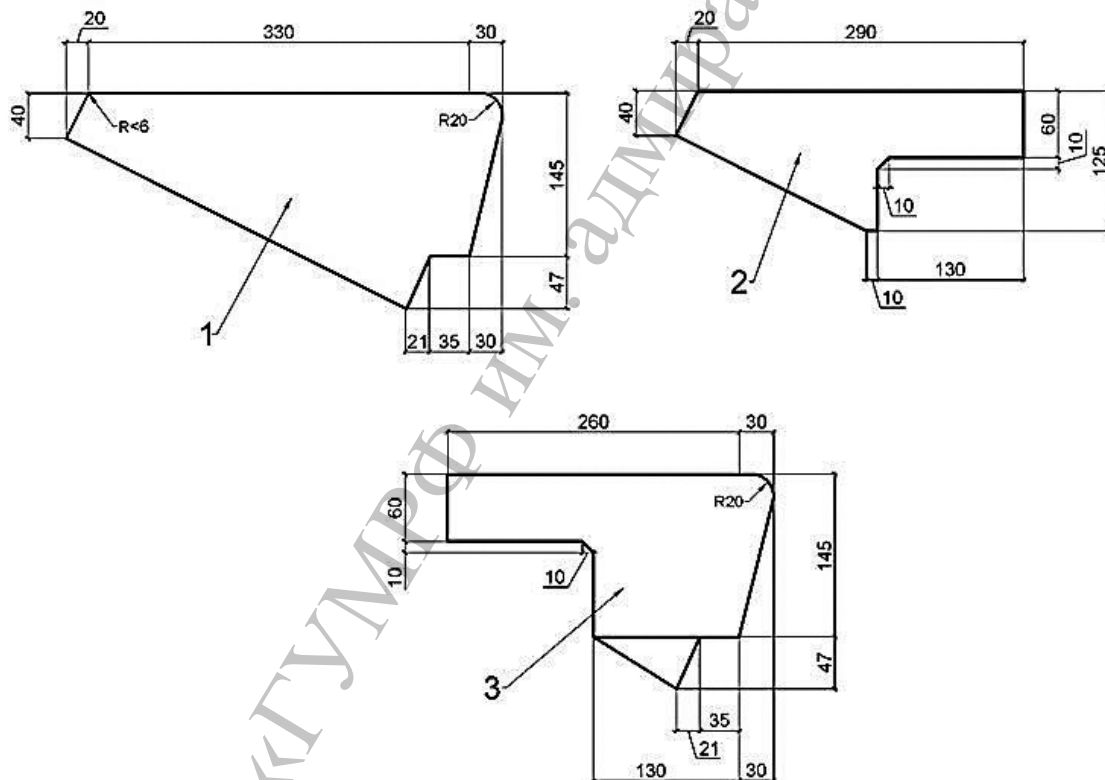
Железобетонные ступени для лестниц (ГОСТ 8717.0-84):
